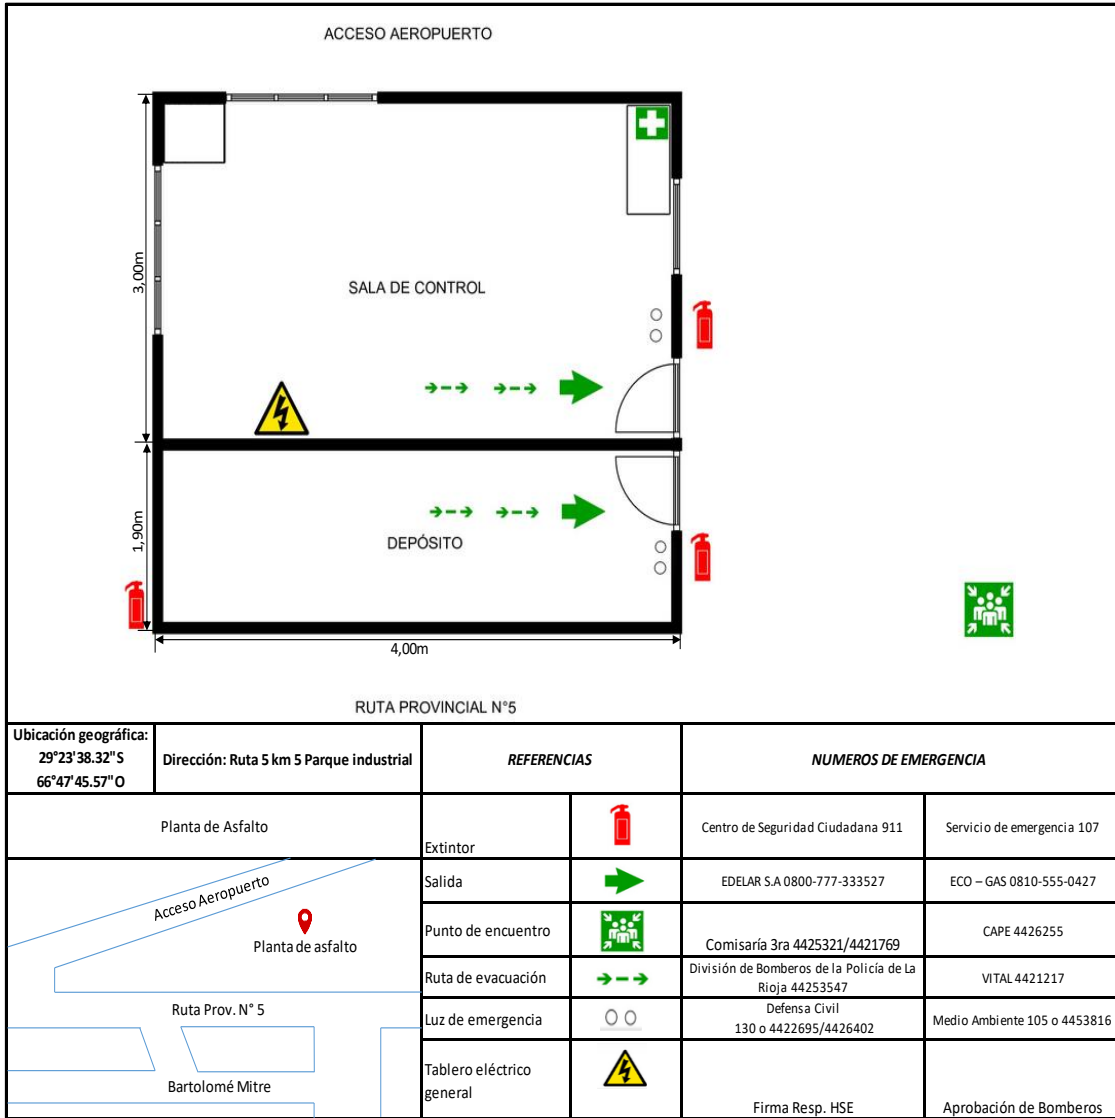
Plano de asfalto plano de evacuación Maggiora S.A 2023
